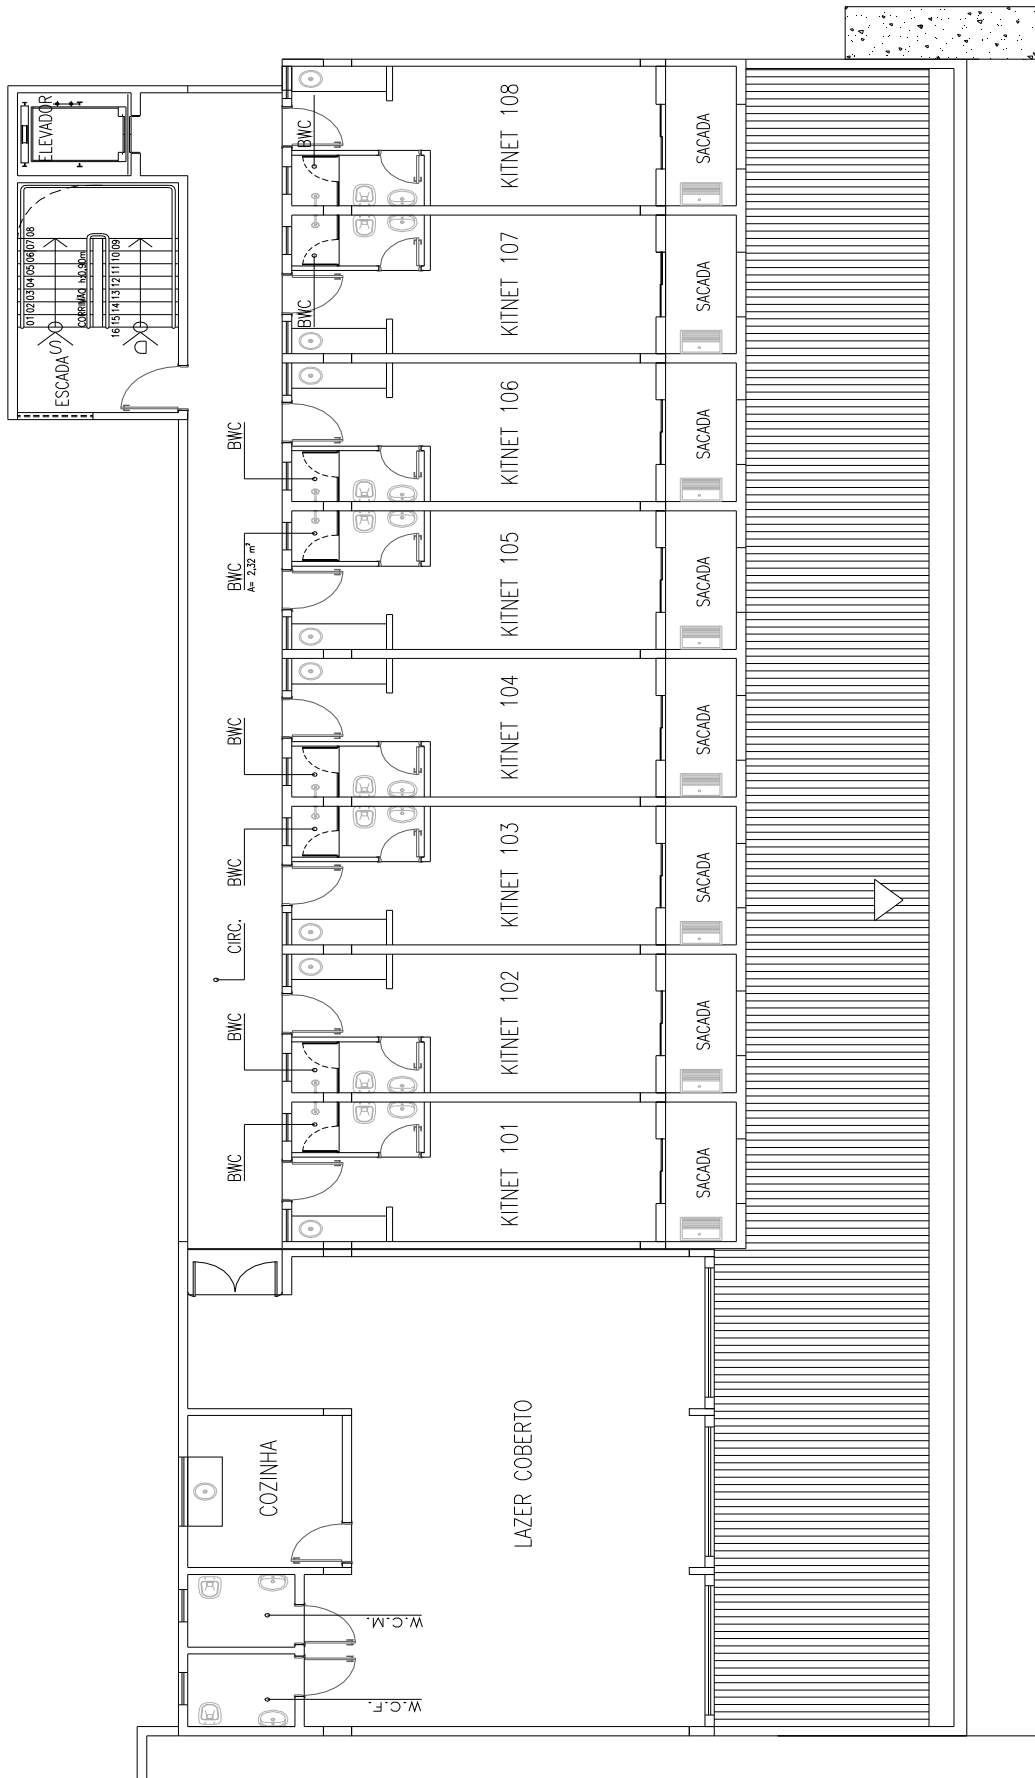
Planta baixa do pavimento tipo – Obra B
